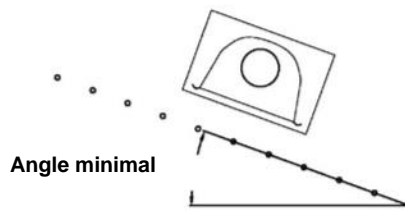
Plan de Mesure d'un Appareil de Chauffage à Infrarouges Faible Intensité Installé en Angle
